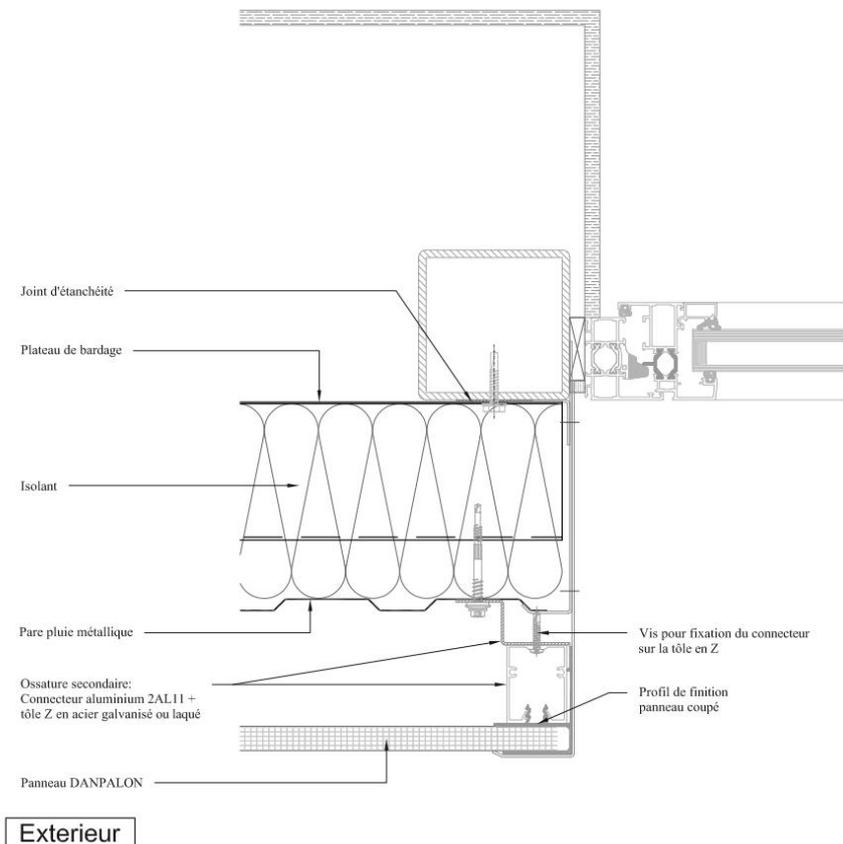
Coupe verticale – tableau de baie- Système DANPALON® BRV sur plateaux métalliques
